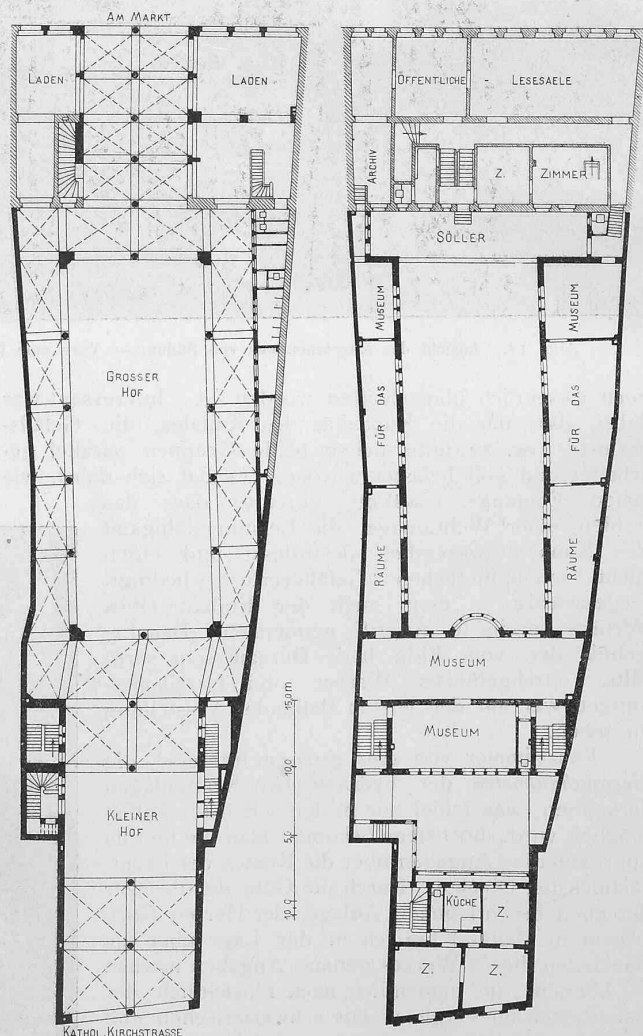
u. 2. Grundrisse des Erdgeschosses und des ersten Obergeschosses
